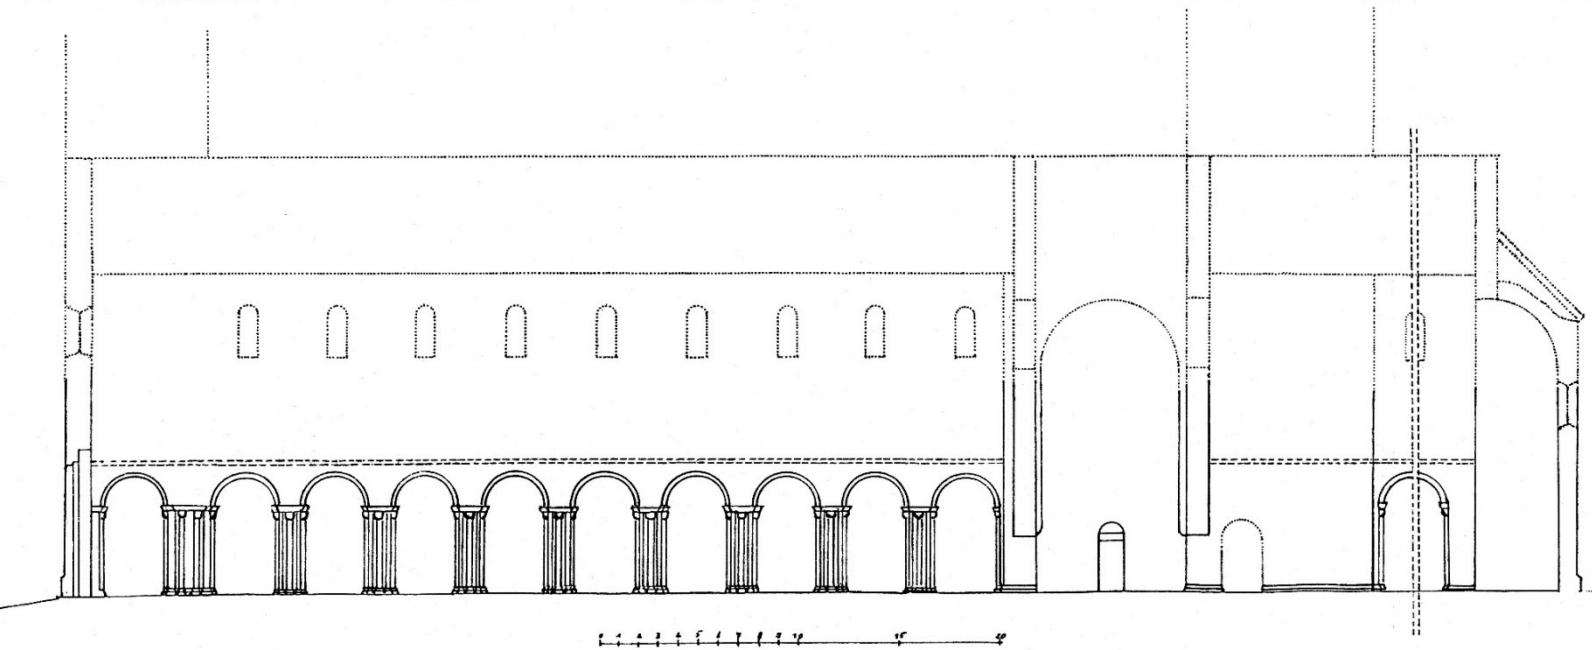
Erfurt, Peterskirche, Wandaufriss des Langhauses nach dem ursprünglichen Entwurf, Haenchen 2000
